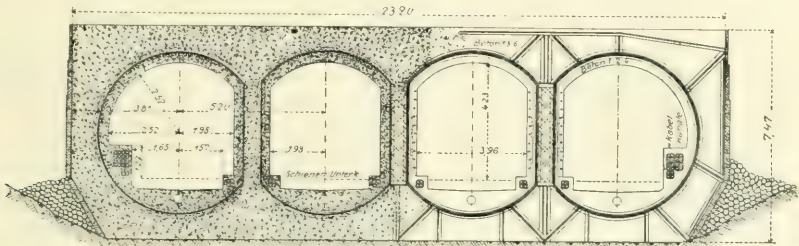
Tunnelanlage der Lexington Avenue-Schnellbahn unter dem Harlemfluß.
